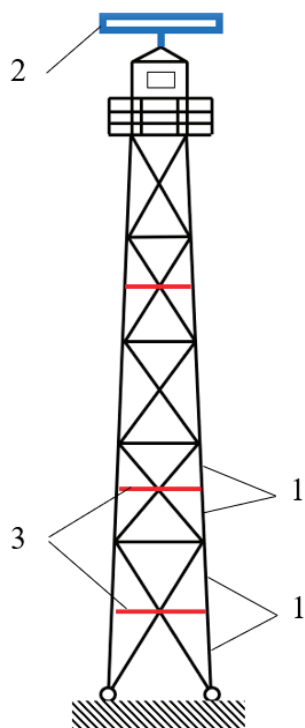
Усиление решётки колонны: 1 — усиливаемые пояса колонны, 2 — новое оборудование, 3 — распорка
